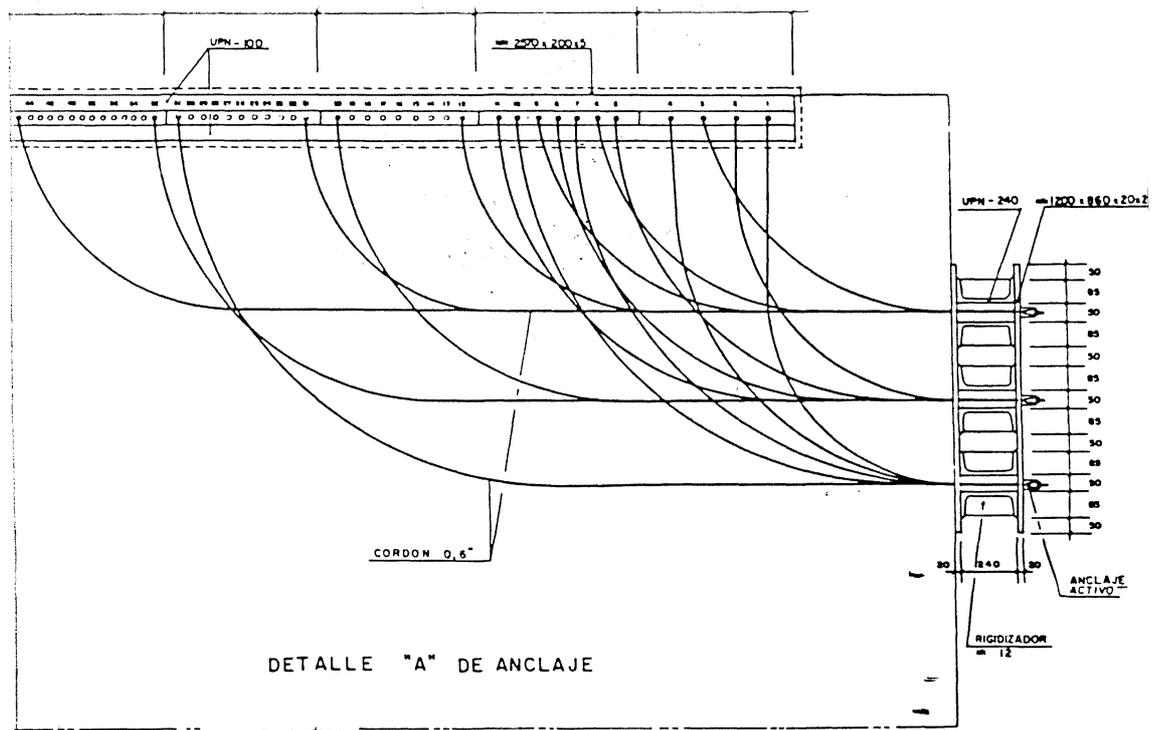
Alzado-sección del refuerzo, con el trazado de los cables, que se posicionaron enhebrándolos entre dos UPN paralelas.
